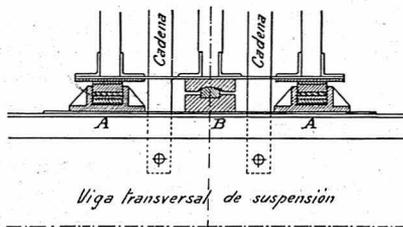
<sup>a</sup> Detalle de los apoyos de las cerchas sobre las vigas de suspensión
